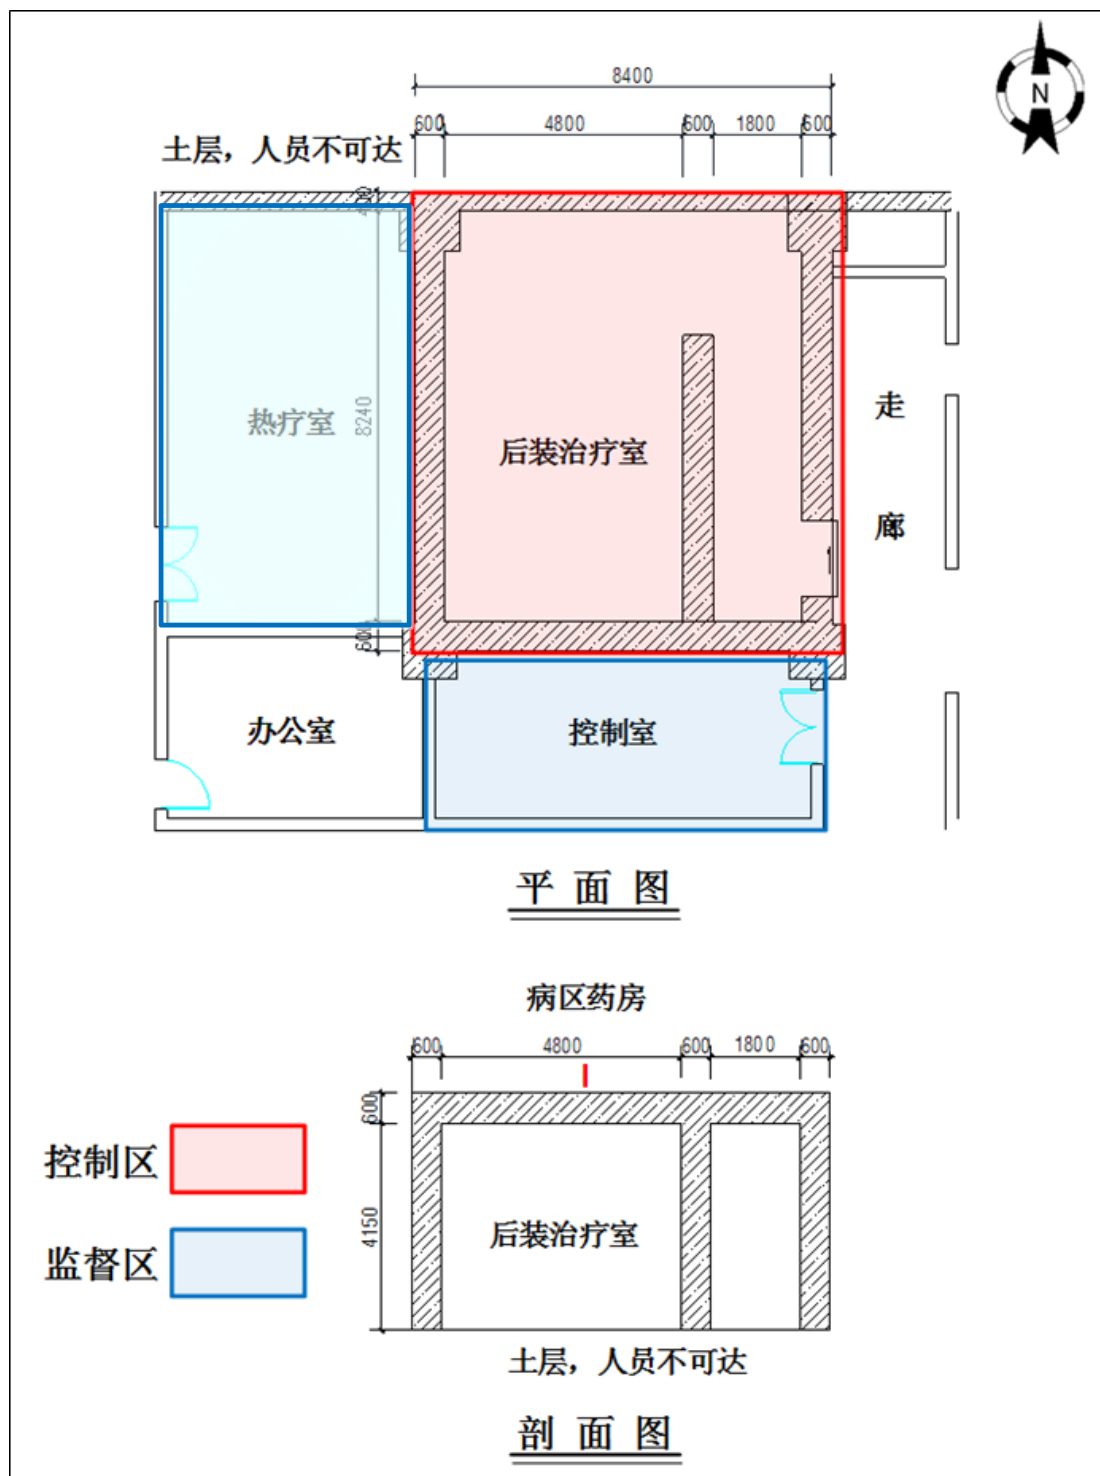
后装治疗机房平面布置及辐射防护分区示意图
